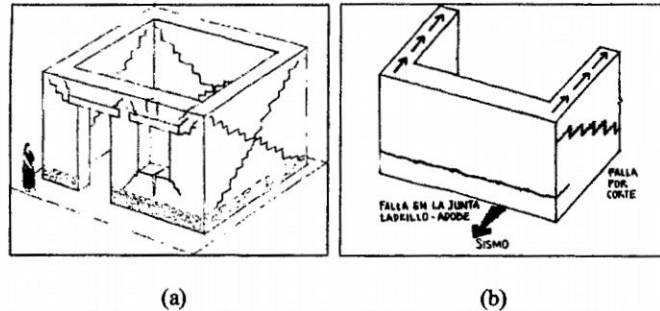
Falla típica por corte (a) Tracción diagonal (b) Tracción horizontal
